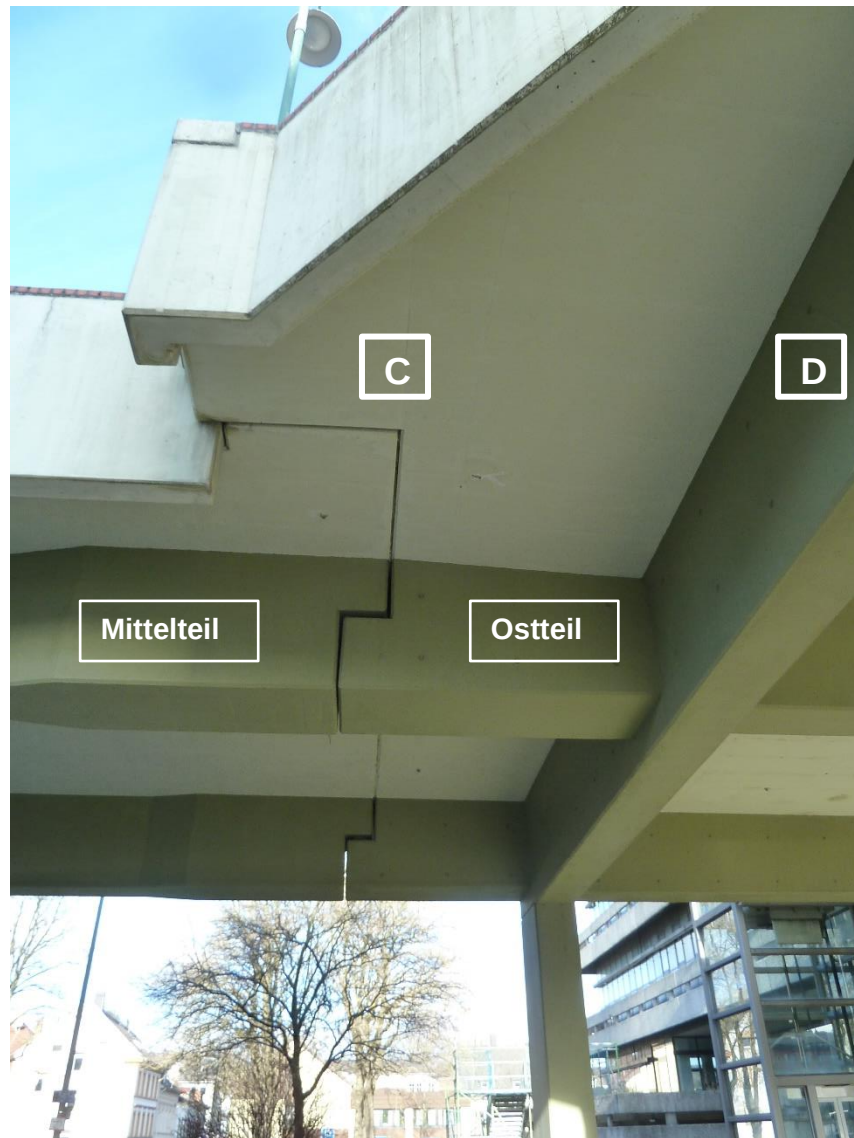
Fuge in Achse C mit Übergang mittlerer zum östlichen Brückenabschnitt
